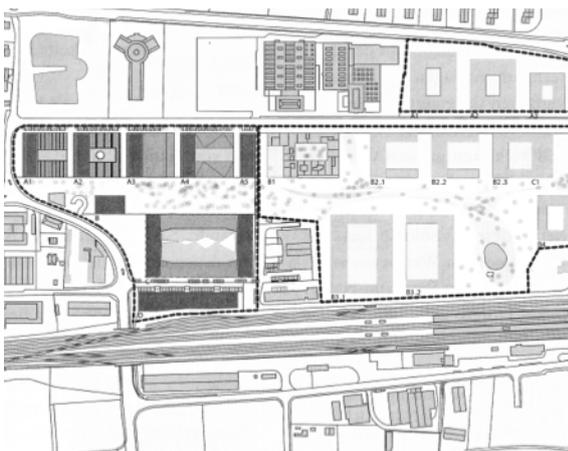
Masterplan Überbauung »Am Rietpark«, Schlieren,
